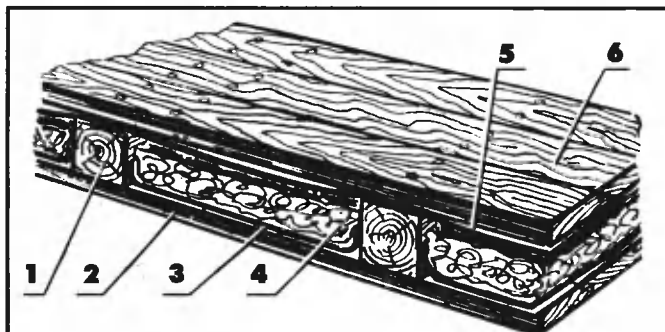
Конструкция межэтажного перекрытия: 1 – балка перекрытия; 2 – потолок; 3 – пергамин; 4 – утеплитель; 5 – пергамин; 6 – пол
